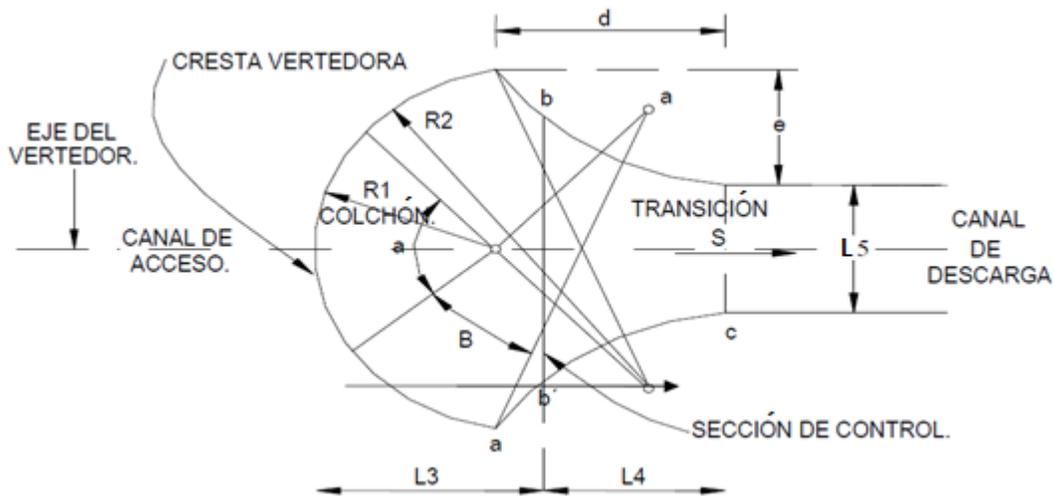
Vista en planta del vertedor de Abanico.
